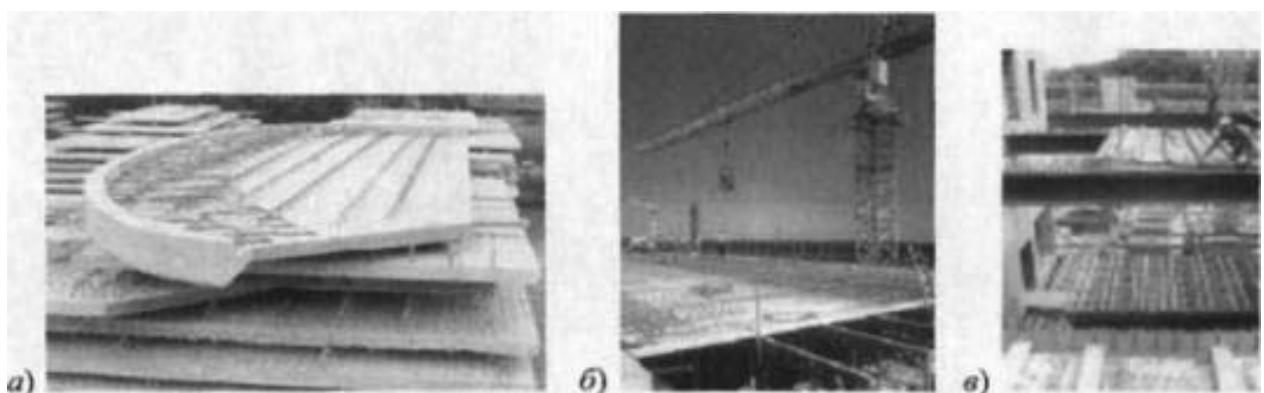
Сборно-монолитные перекрытия с несъемной опалубкой
